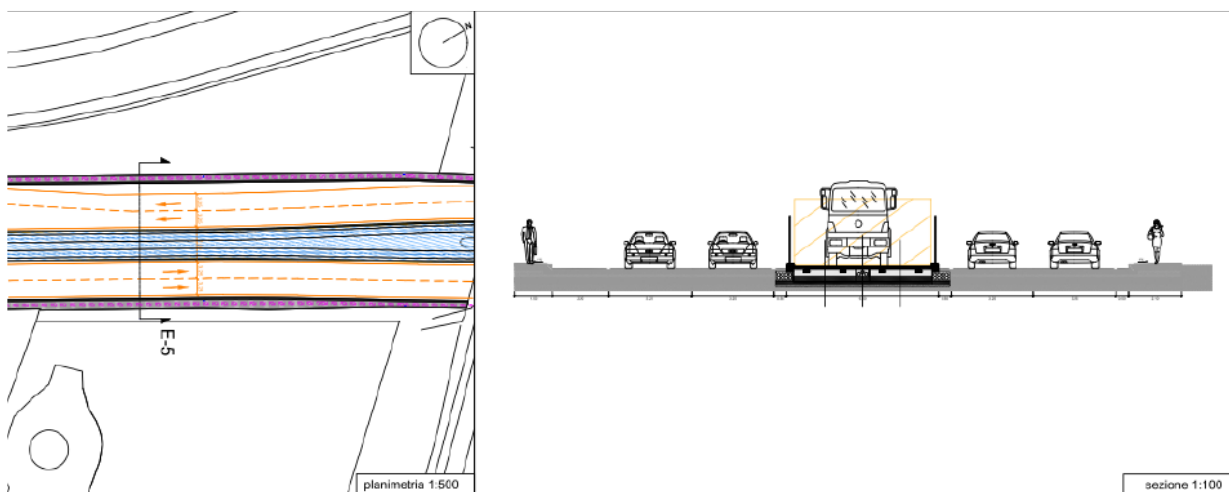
Tipologico cantiere con sede centrale Fase 4
